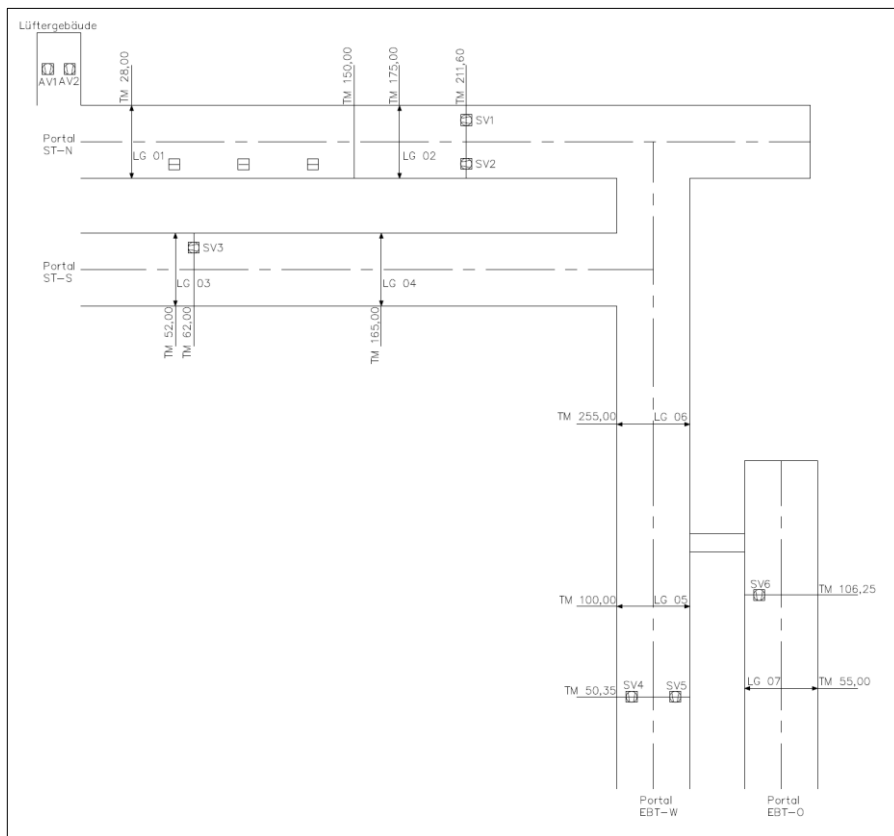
Grundriss der Tunnelröhren mit Messstellen und Ventilatoren
